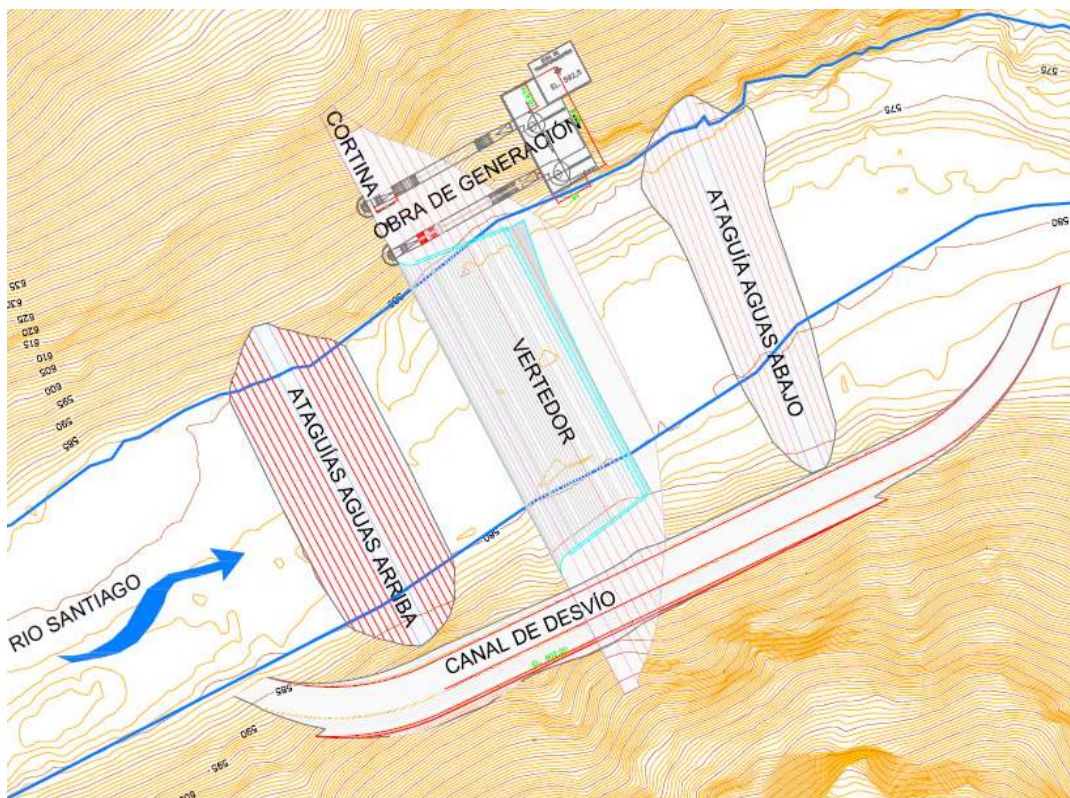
Vista en planta del arreglo de las obras para la alternativa 1
